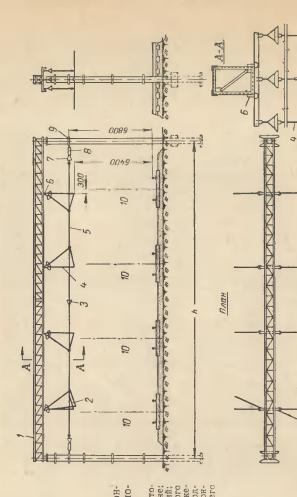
Поперечная подвеска контактных проводов на жестких поперечинах.
